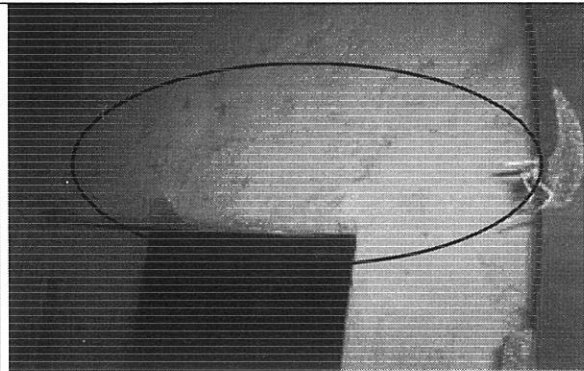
Fisuras en muros de la habitación de la zona frontal
